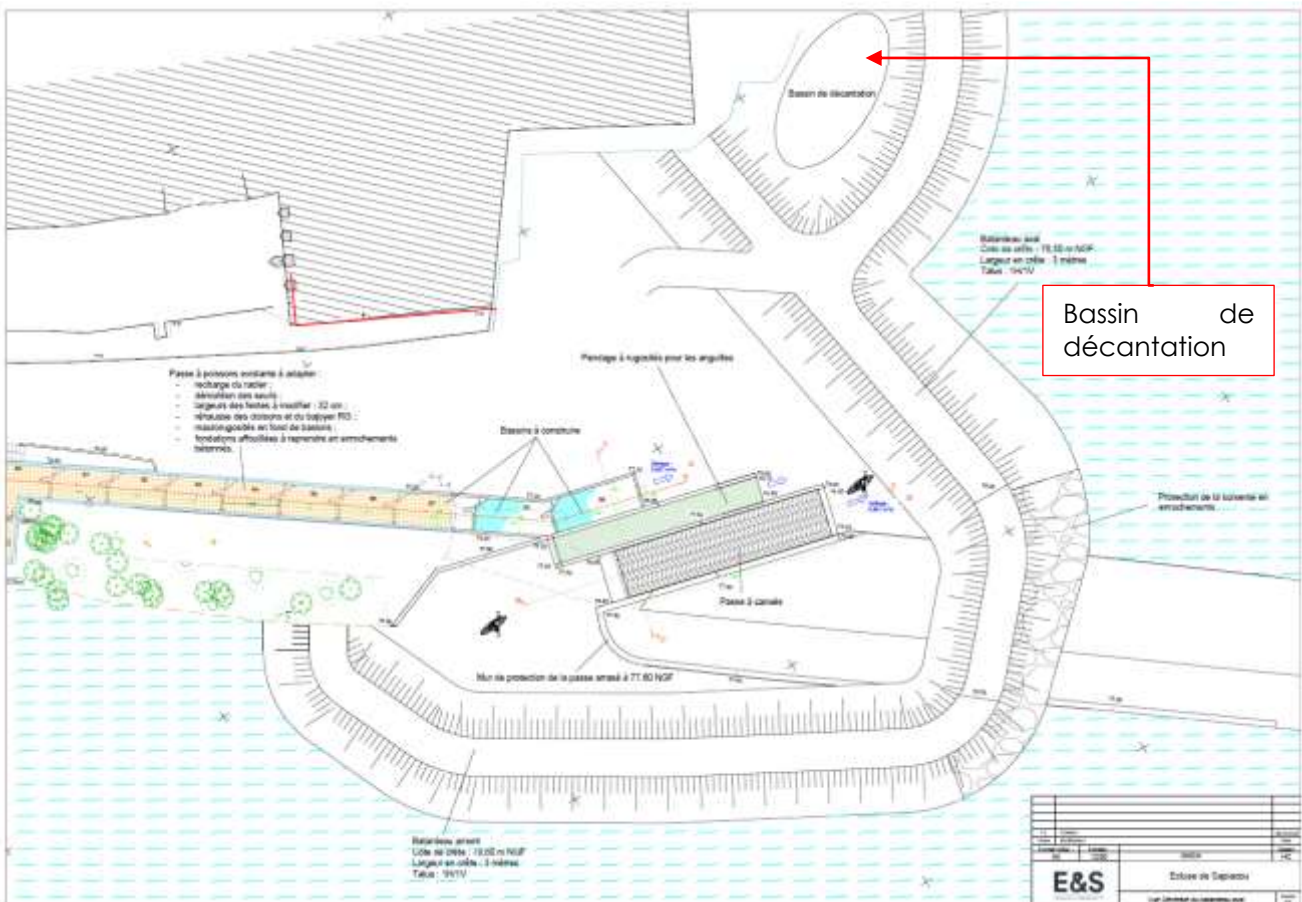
Illustration du plan du batardeau aval en matériaux argileux
